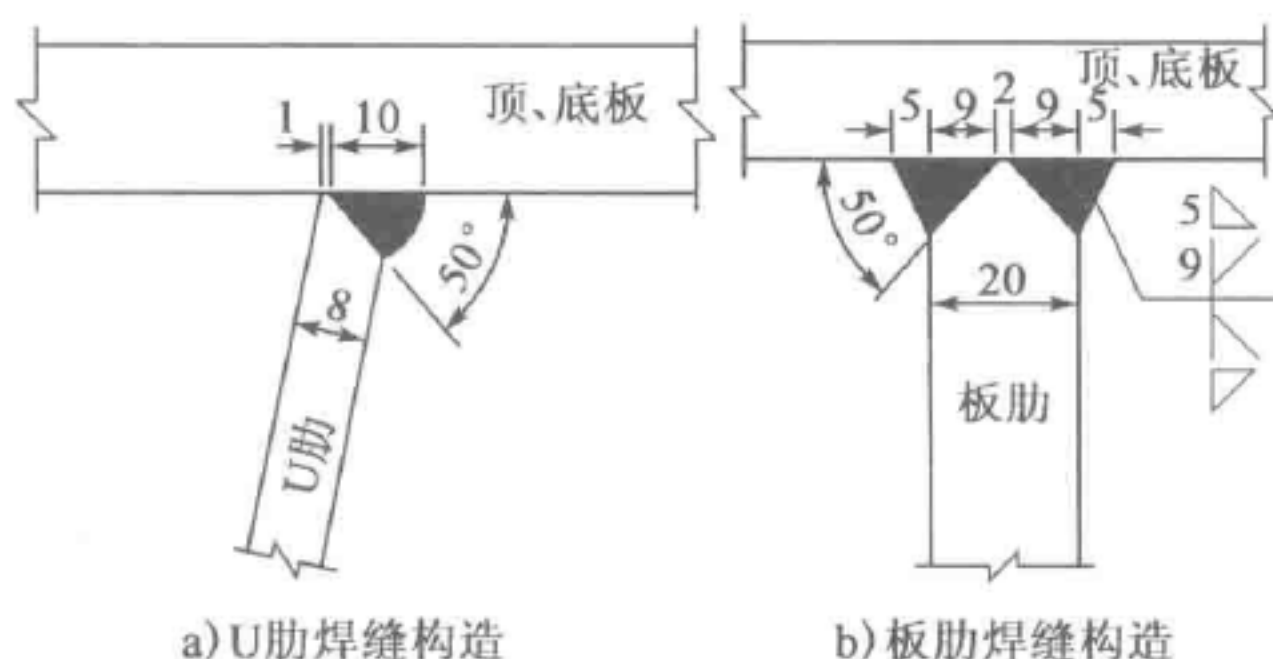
顶底板与加劲肋连接焊缝构造(尺寸单位:mm)
